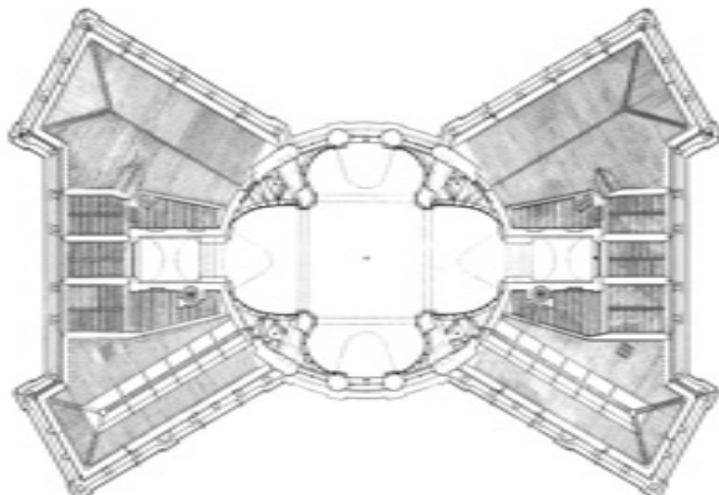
Stupinigi. Fondazione Palazzina Mauriziana di Stupinigi. Salone centrale e appartamenti Reali. Pianta del manto di copertura
